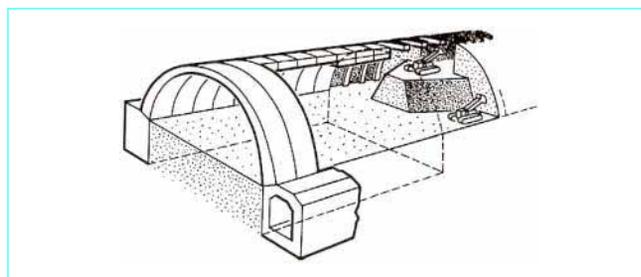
Creusement des galeries de piédroits, voûte et stross
